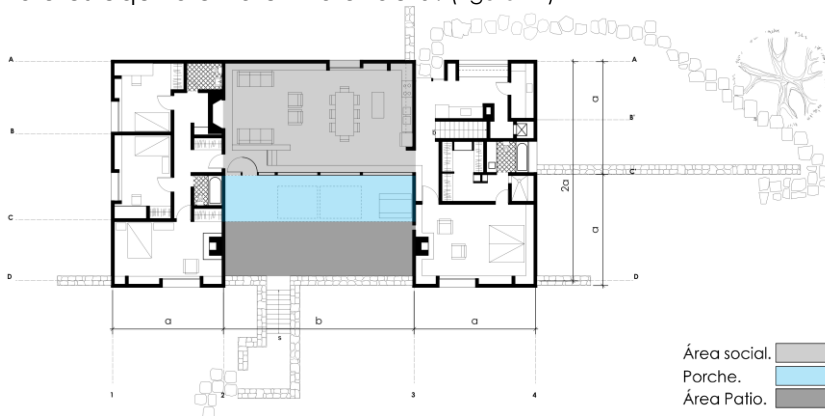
Proporciones del porche en planta baja edificación. Fuente: Autor.
